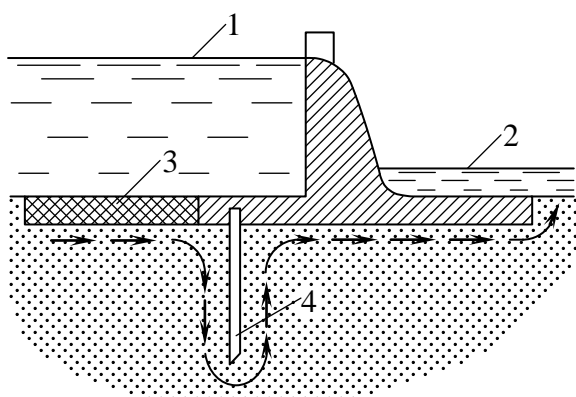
Водозливна бетонна гребля на піщаній основі:
